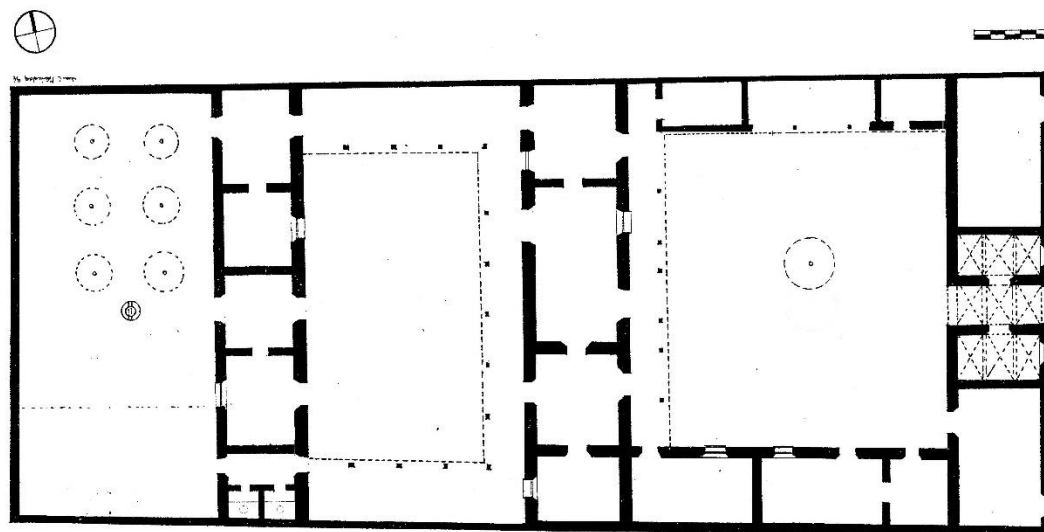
Planta de la Casa en 1838 según el inventario, plano de 1870 y posteriores y entrevistas. Elaboración propia
